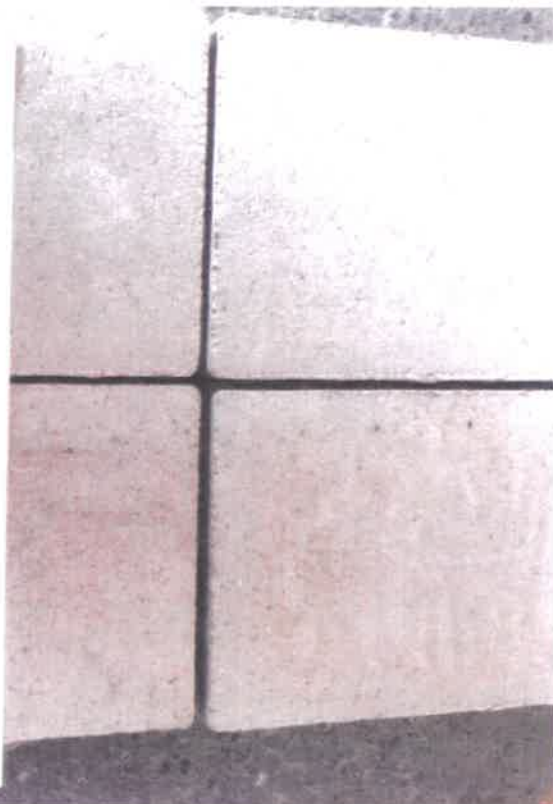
Die zu prüfende Betonoberfläche VELVET Concrete 3D, hydrophobiert, im aufgebauten Zustand.
